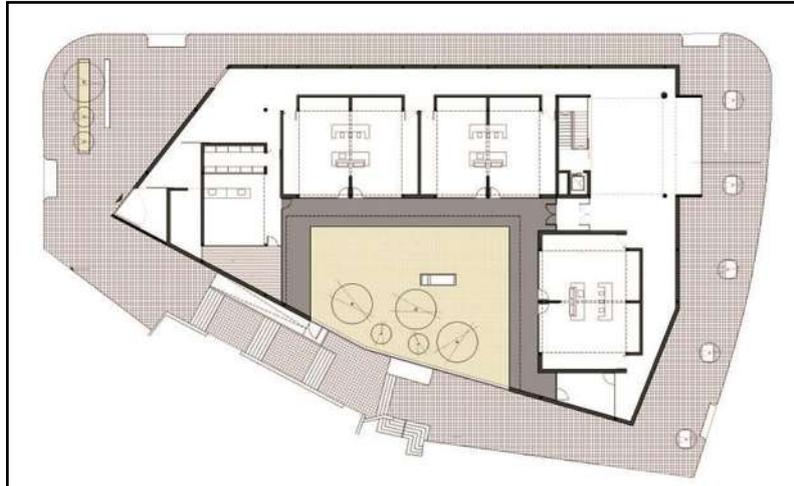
Planta arquitectónica en donde se muestra la planta superior con las aulas alrededor del patio. Fuente: ARQA
